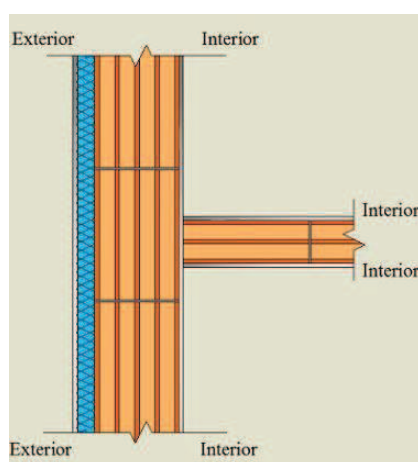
Exemplo de isolamento na parede pelo exterior (Fonte: IteCons, 2011).
